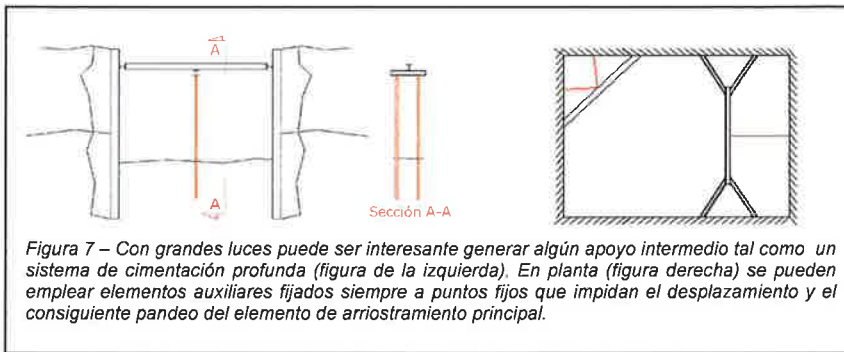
Con grandes luces puede ser interesante generar algún apoyo intermedio tal como un sistema de cimentación profunda (figura de la izquierda). En planta (figura derecha) se pueden emplear elementos auxiliares fijados siempre a puntos fijos que impidan el desplazamiento y el consiguiente pandeo del elemento de arriostramiento principal.
